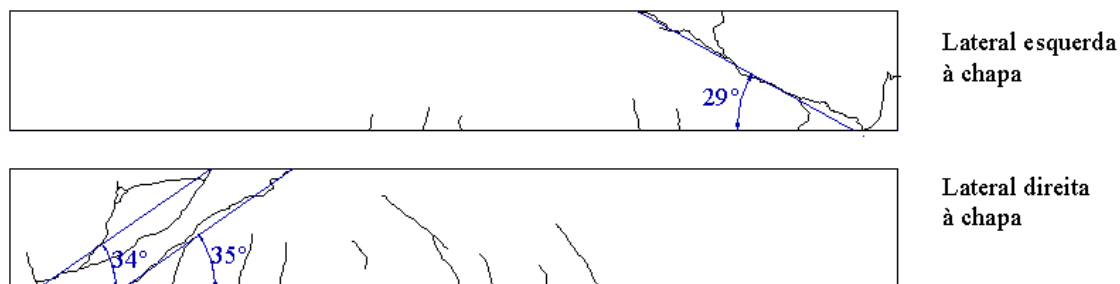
Fissuração na viga V2 e inclinações das fendas
